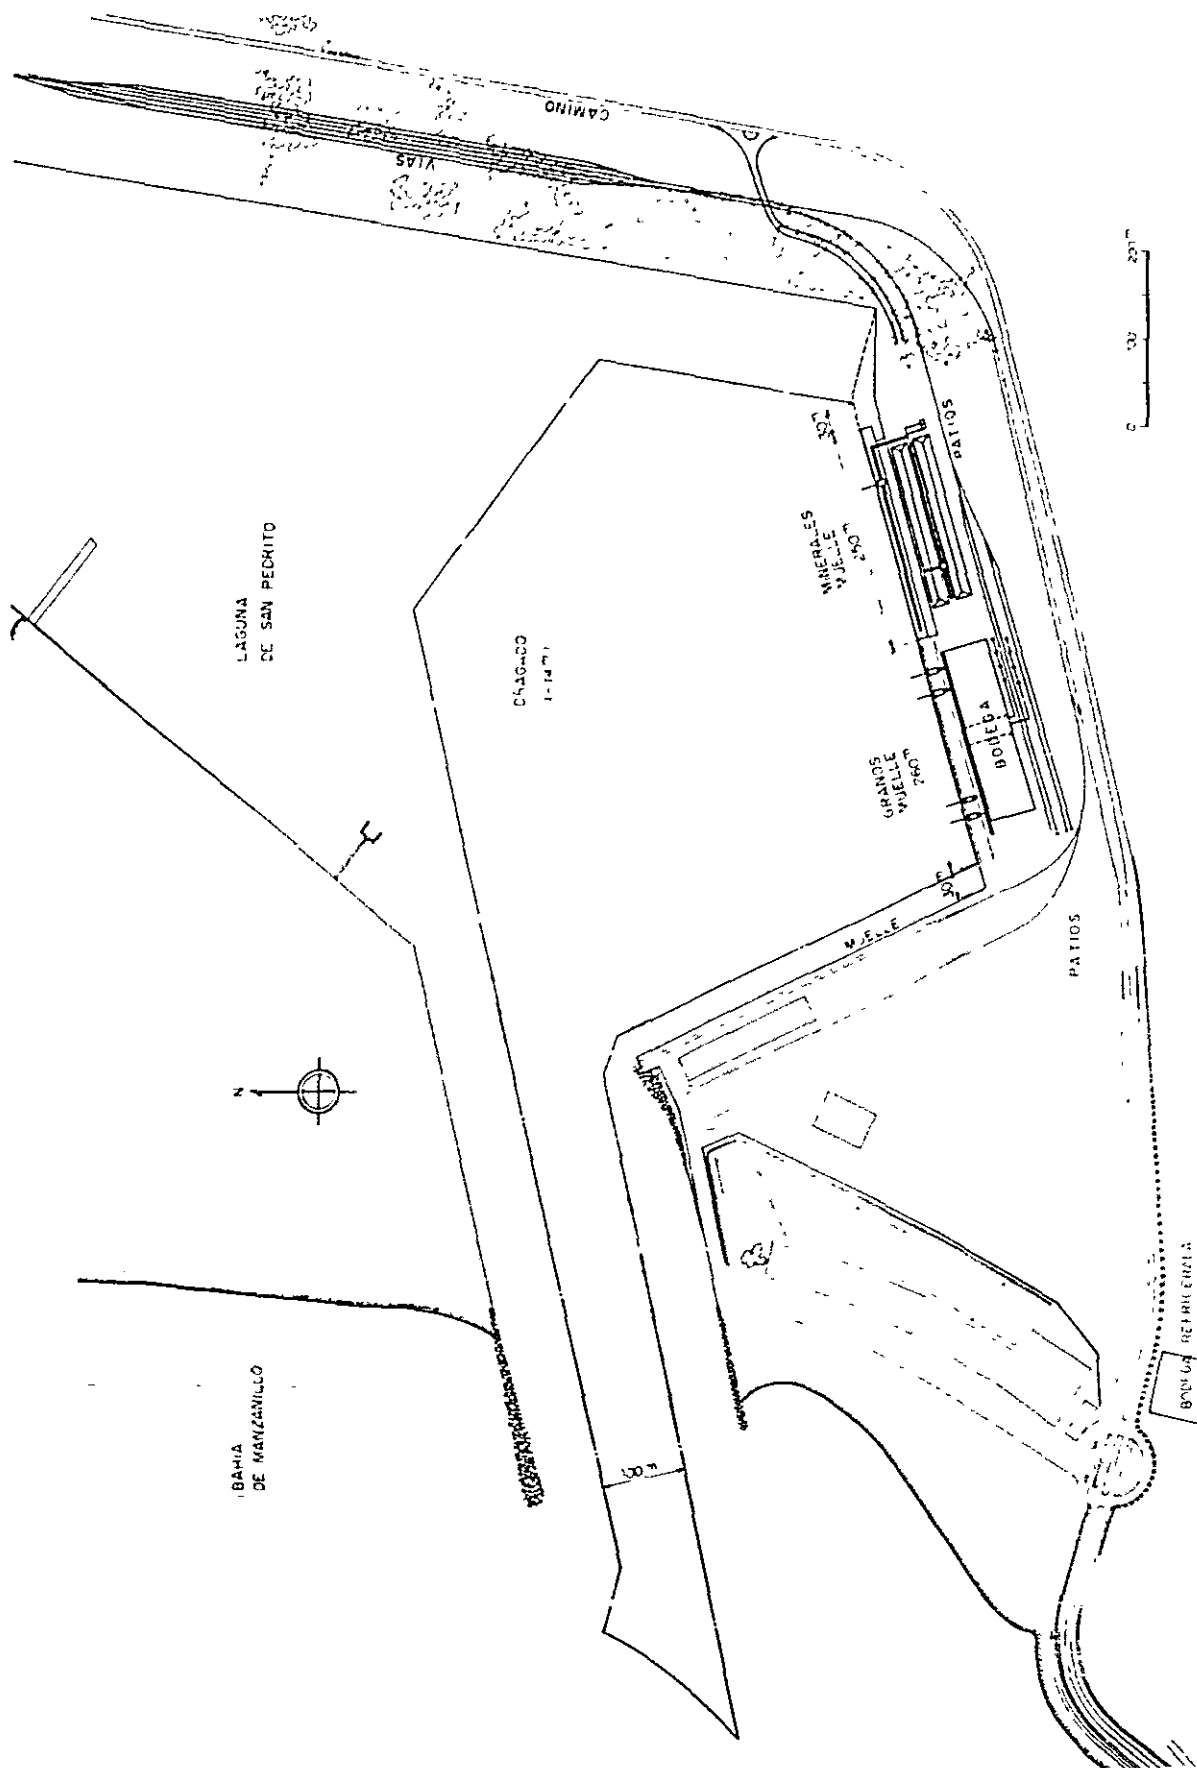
PLAN DE OBRAS PORTUARIAS Y EQUIPO EN MANZANILLO
